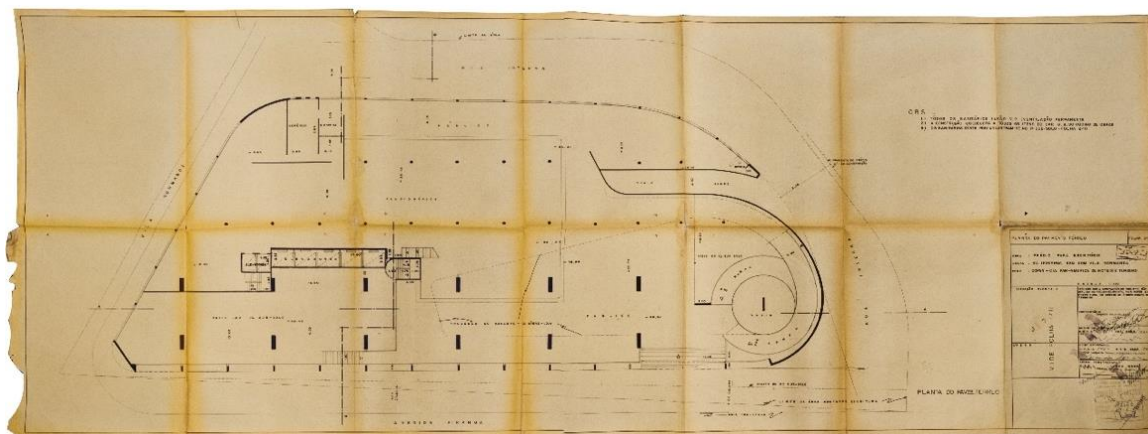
Planta do pavimento térreo. Fonte: Fupam/DPH, 2012.
